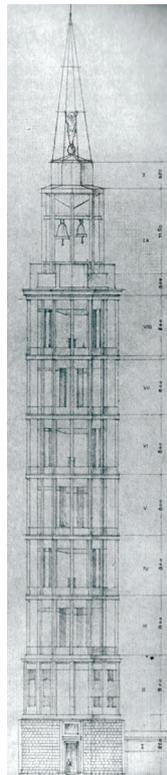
P. Zanini, Prospetto e sezione schematica del campanile. Archivio Zanini, Civici Musei, Udine.
